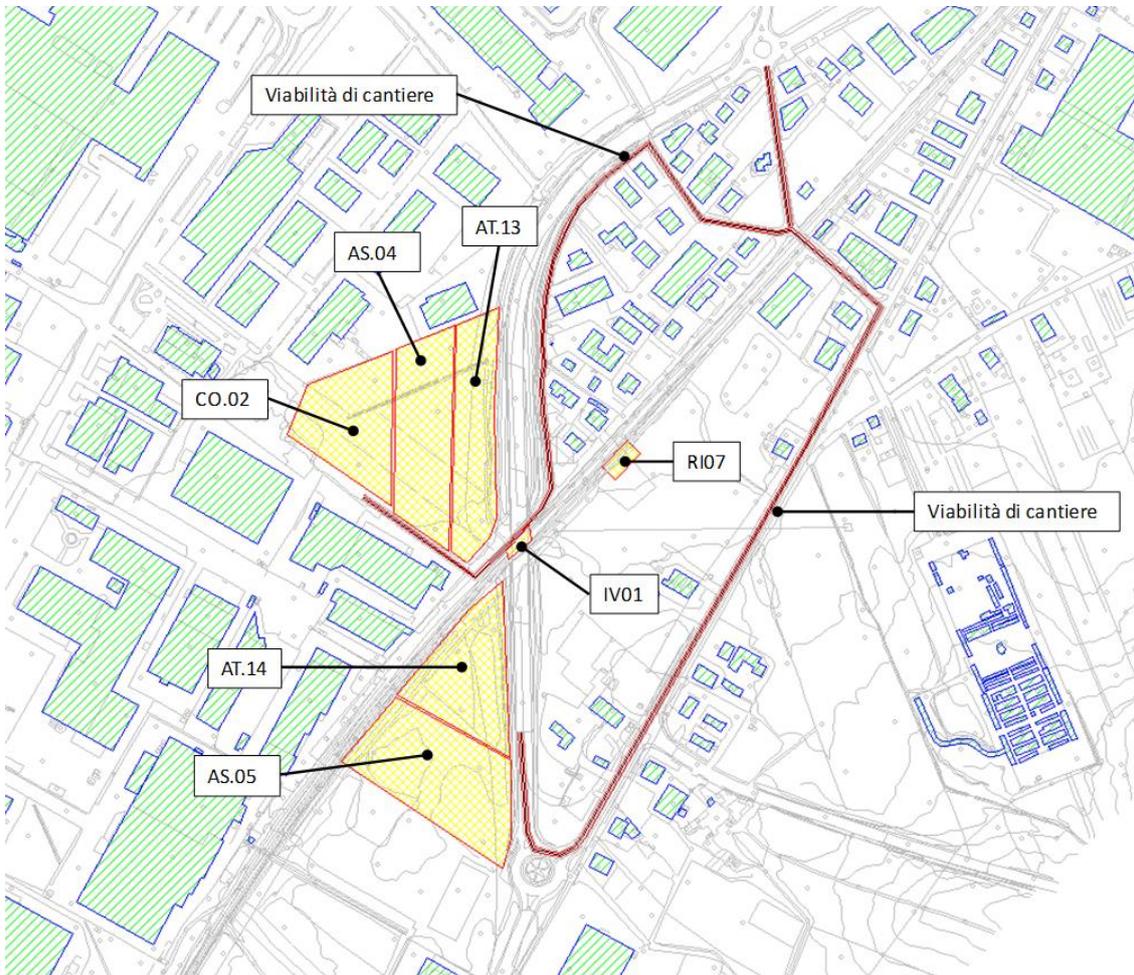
Scenario di simulazione 01 – Sambuceto: Planimetria in SoundPlan dello scenario oggetto di simulazione
